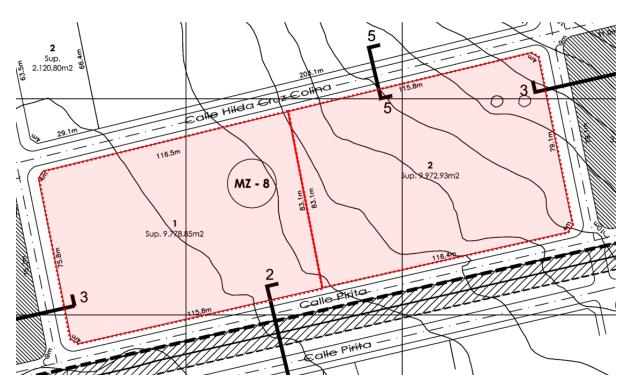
Ubicación Lotes 1 y 2 de la MZ-8. Fuente: Extracto Plano Anteproyecto de Loteo Etapa II, Seremi MINVU.
